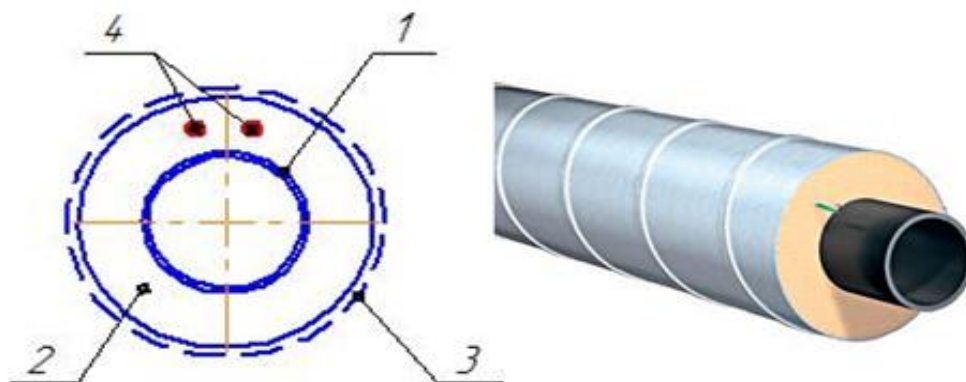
Попередньо ізольований трубопровід для надземної прокладки:
